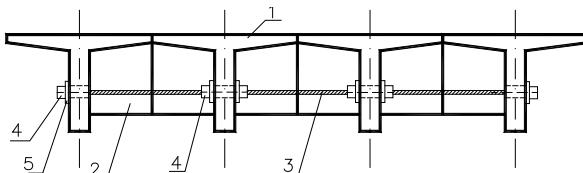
Поперечное обжатие напрягаемым арматурным элементом винтового профиля, закрепляемым после натяжения на стенах крайних и промежуточных балок: 1 – балка; 2 – полуудиафрагма; 3 – арматурный стержень винтового профиля; 4 – фиксирующее устройство; 5 – упорная шайба
